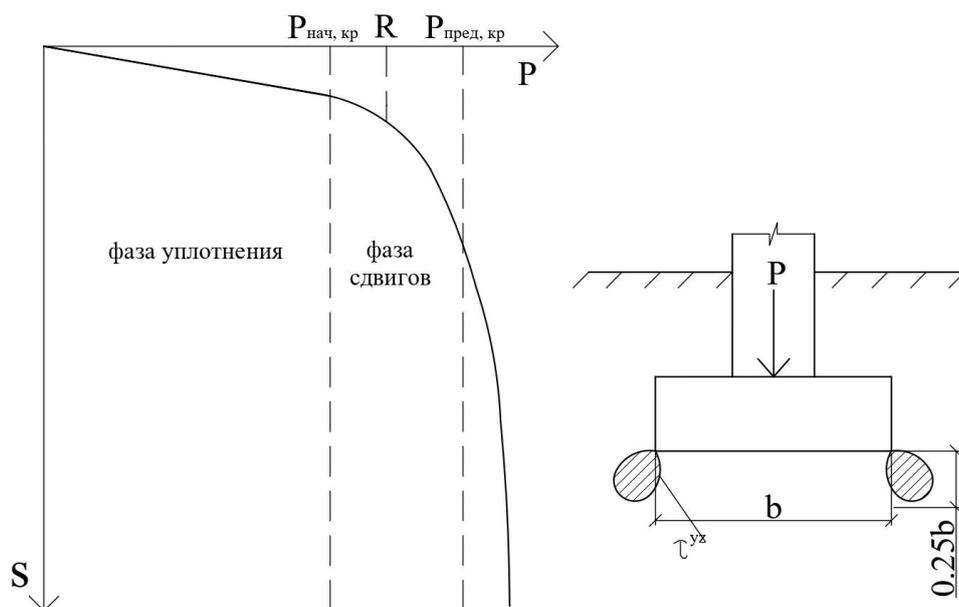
Фаза уплотнения и фаза сдвигов при уточнении расчетного сопротивления грунта – R
